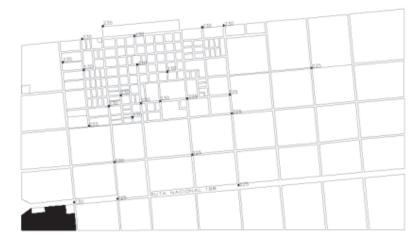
Plano de ubicación de la planta depuradora de la localidad de Rancul. Se marcan en negro las 12.62 hectáreas destinadas al proyecto.
